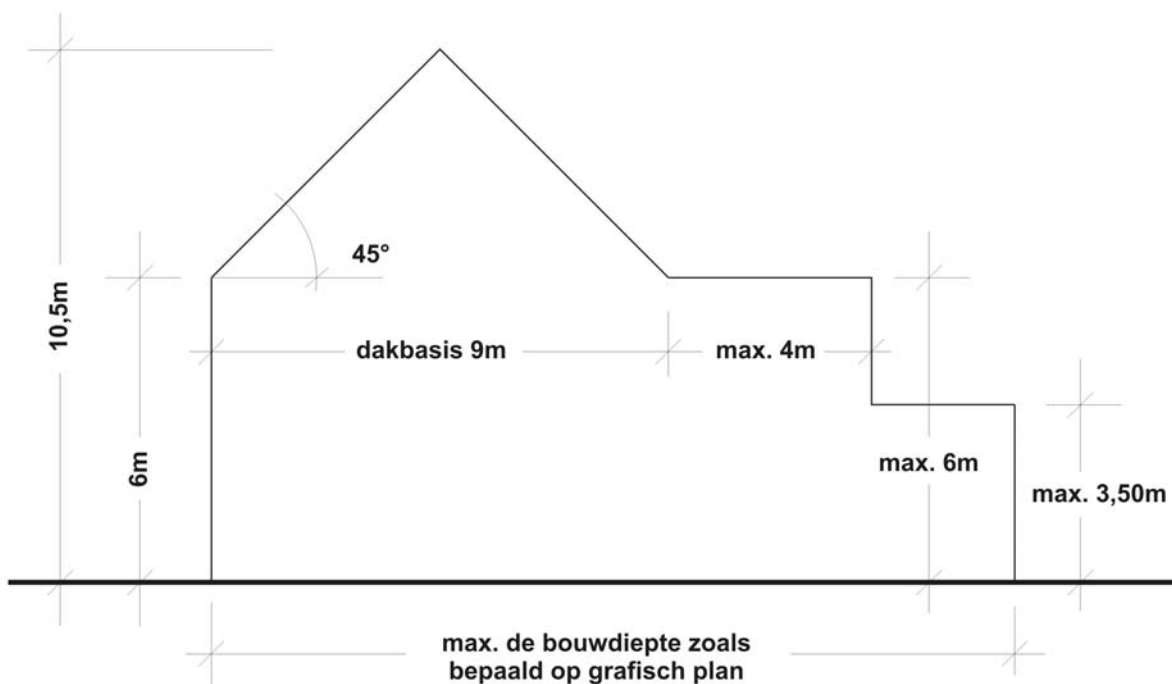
halfopen bebouwing: plaatsing gebouwen
